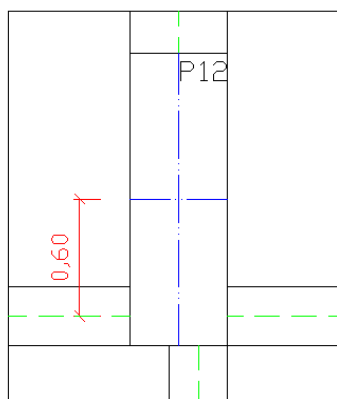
Ligação do Pilar 12 às respectivas vigas
